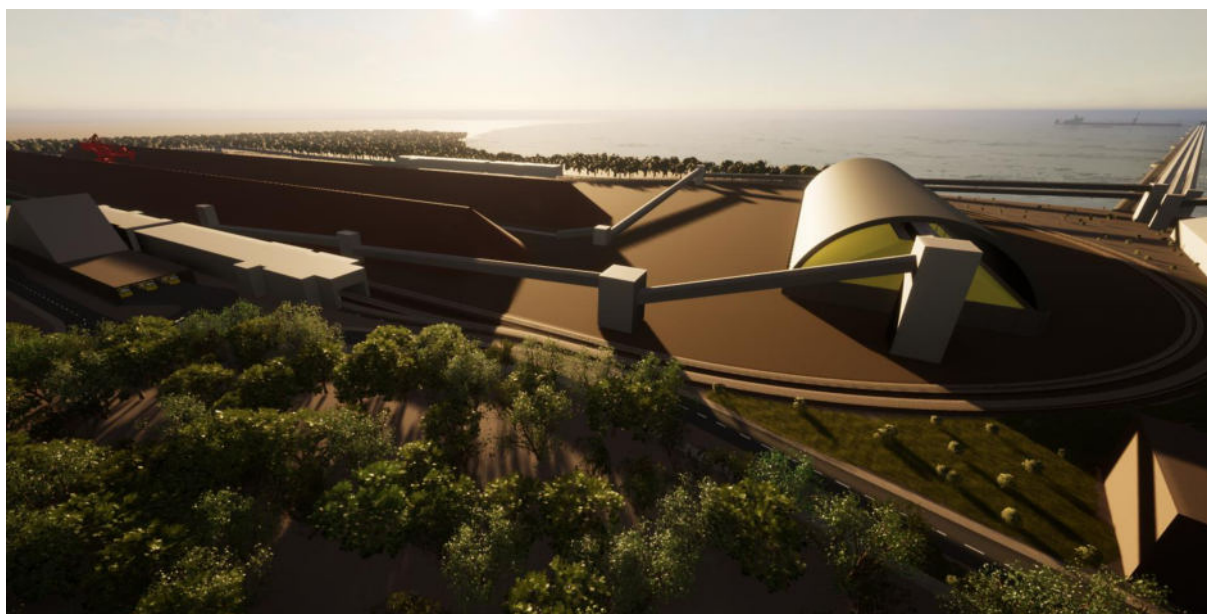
Imagem Renderizada – Estruturas onshore. Fonte: INFRAS Eng.
